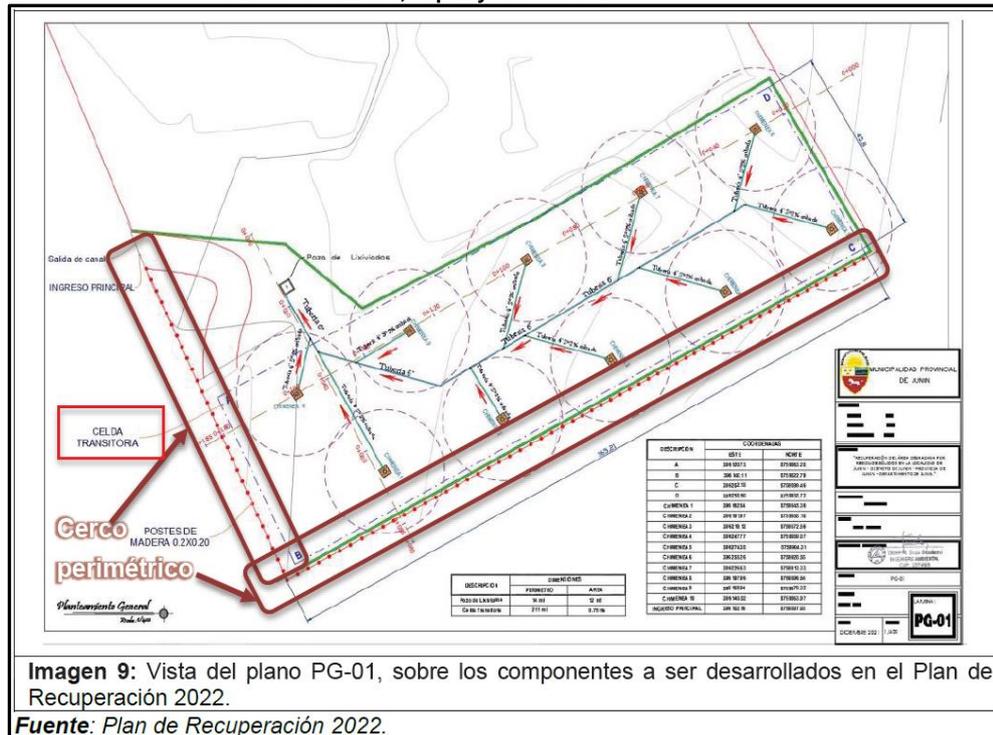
Vista del plano PG-01, sobre los componentes a ser desarrollados en el Plan de Recuperación 2022.
